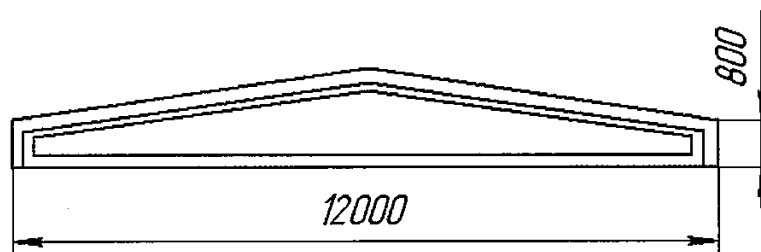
Железобетонная ферма серии 1.462-3
